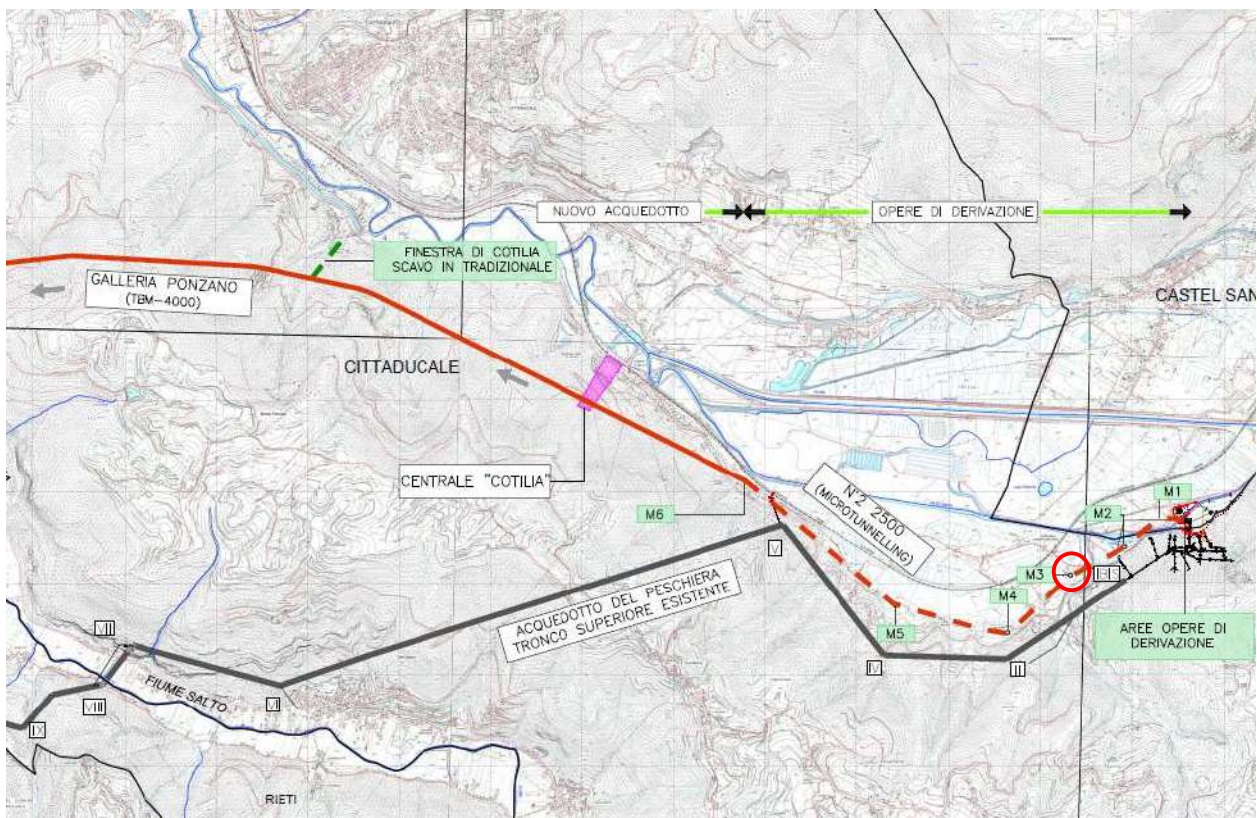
Ubicazione del Manufatto M3 – vista planimetrica
